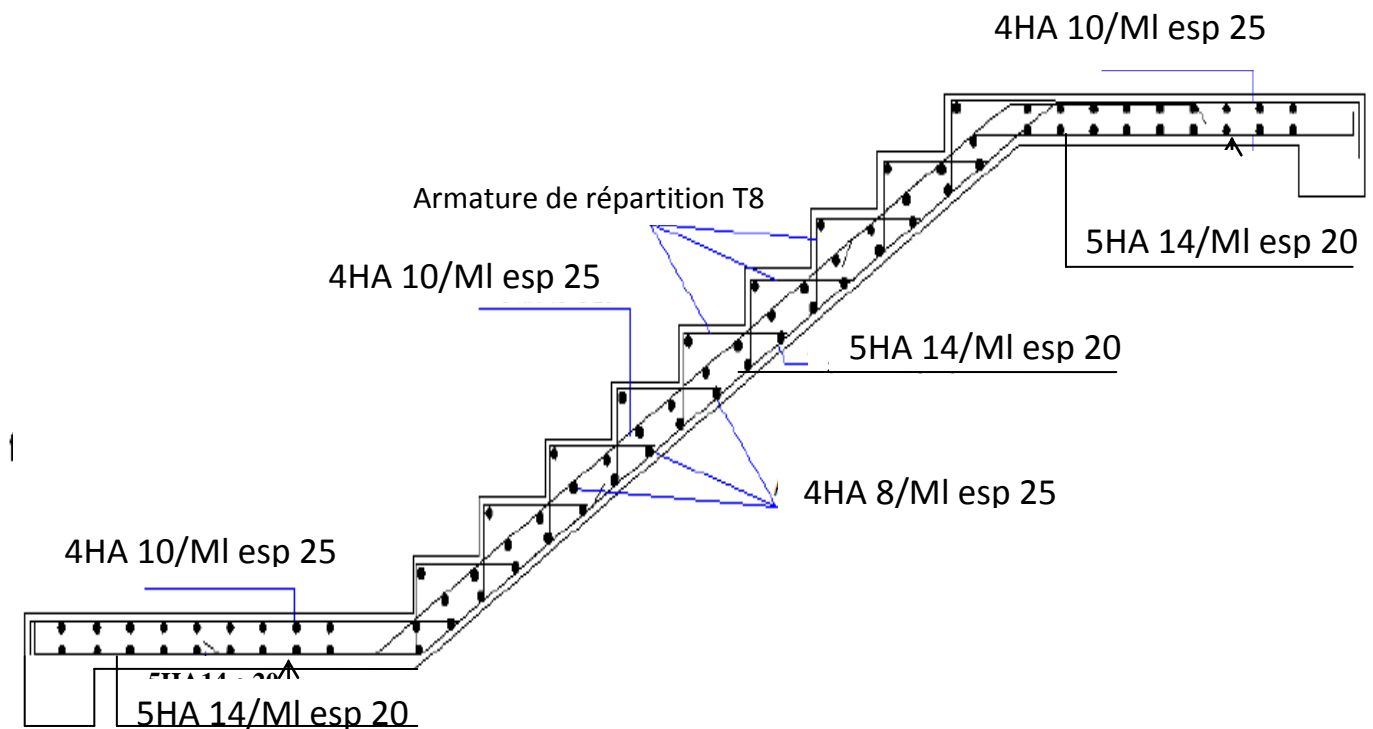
Schéma de ferrailage d'escalier du RDC.
